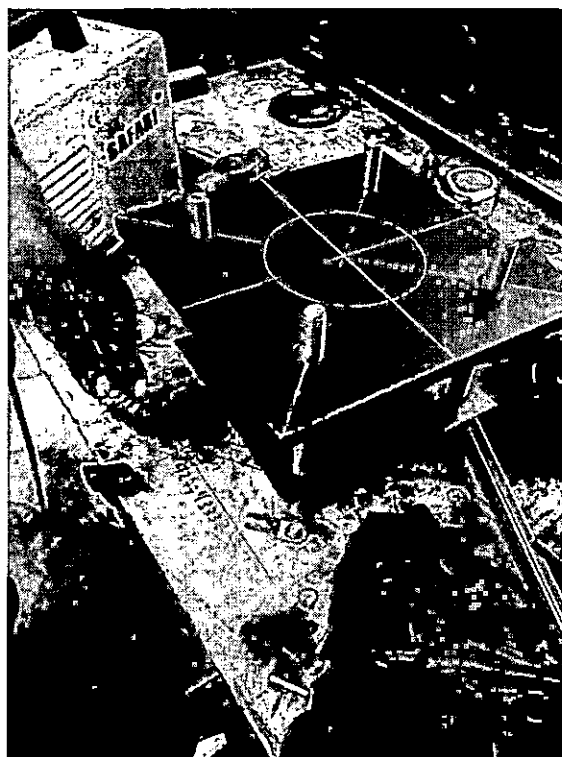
Pernos con planchas guías y pernos para nivelar plancha de fijación
